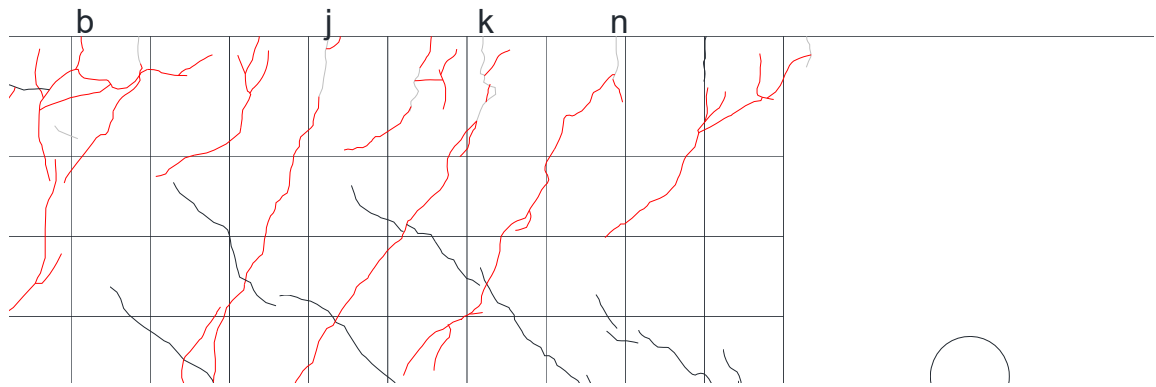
基礎梁ひび割れ測定位置 (試験体 E-2 負荷荷)
